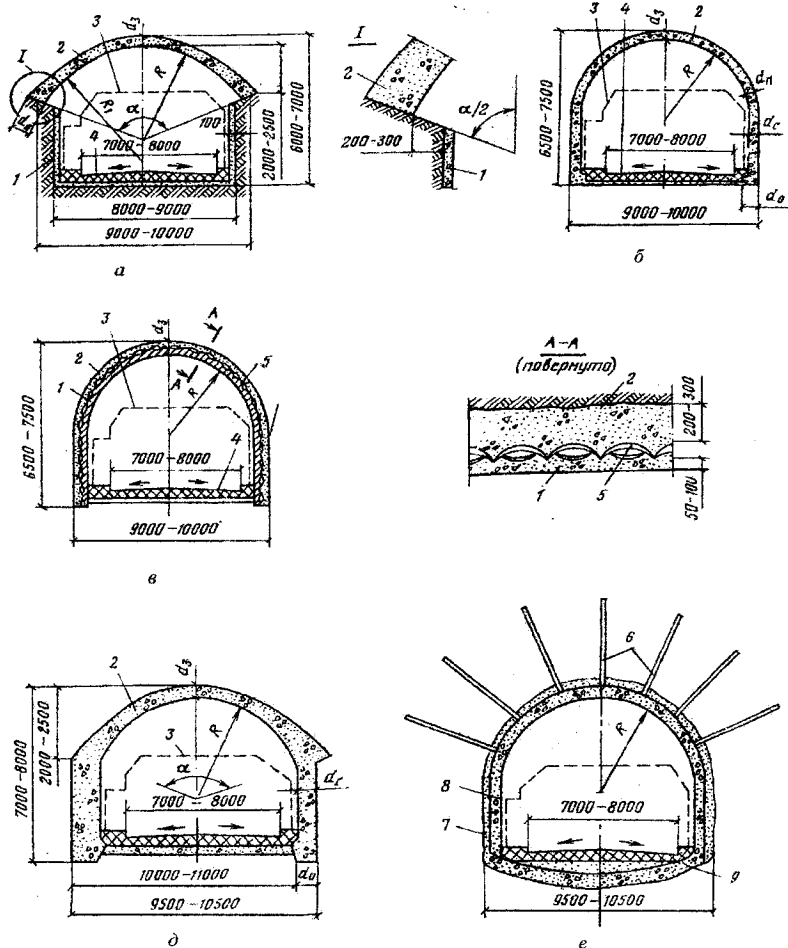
Конструкції монолітних кріплень склепінного окреслення (а-е):
